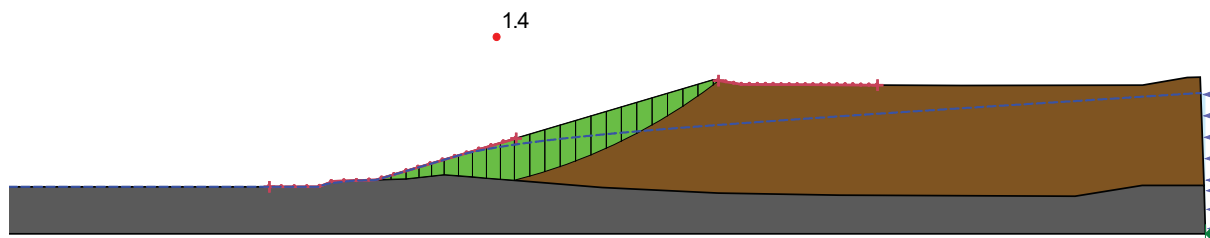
Stabilité court terme, pente d'excavation 3.5H:1V, excavation dans des sols argileux
